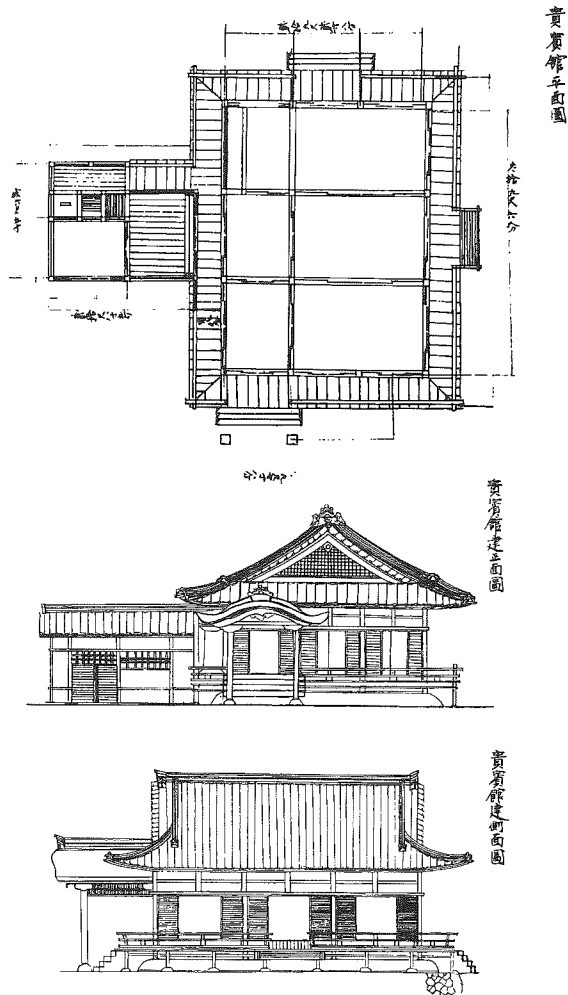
尚美館 平面図、正面図、東側面図 (大正3年)
